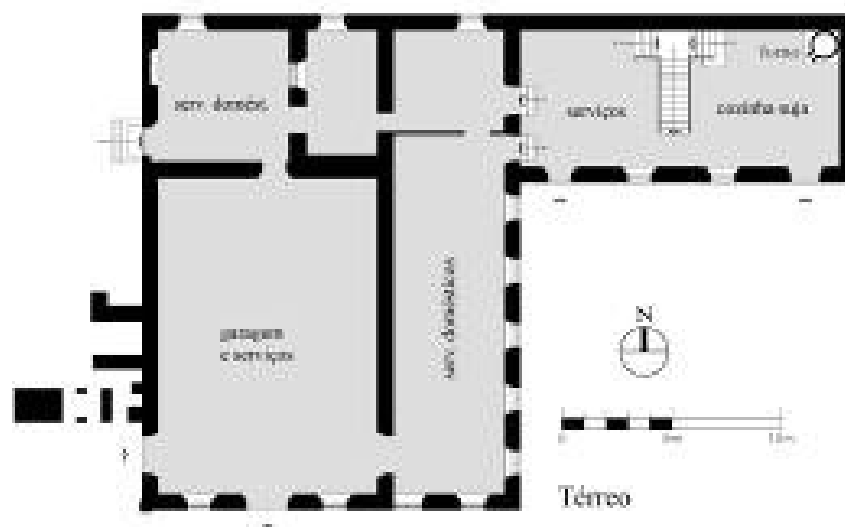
Planta do térreo: serviços. Desenho: Benincasa, 2003.
